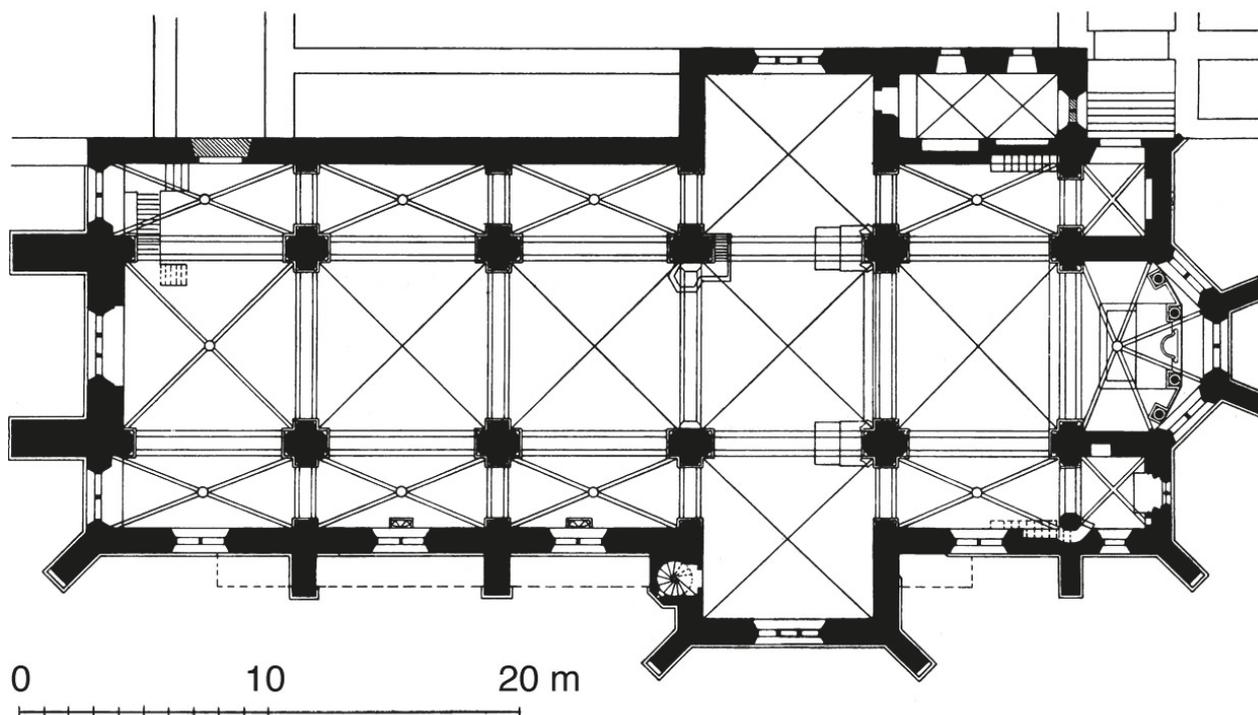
Marienrode, Grundriss der Zisterzienserkirche (aus: Siebern 1910).
